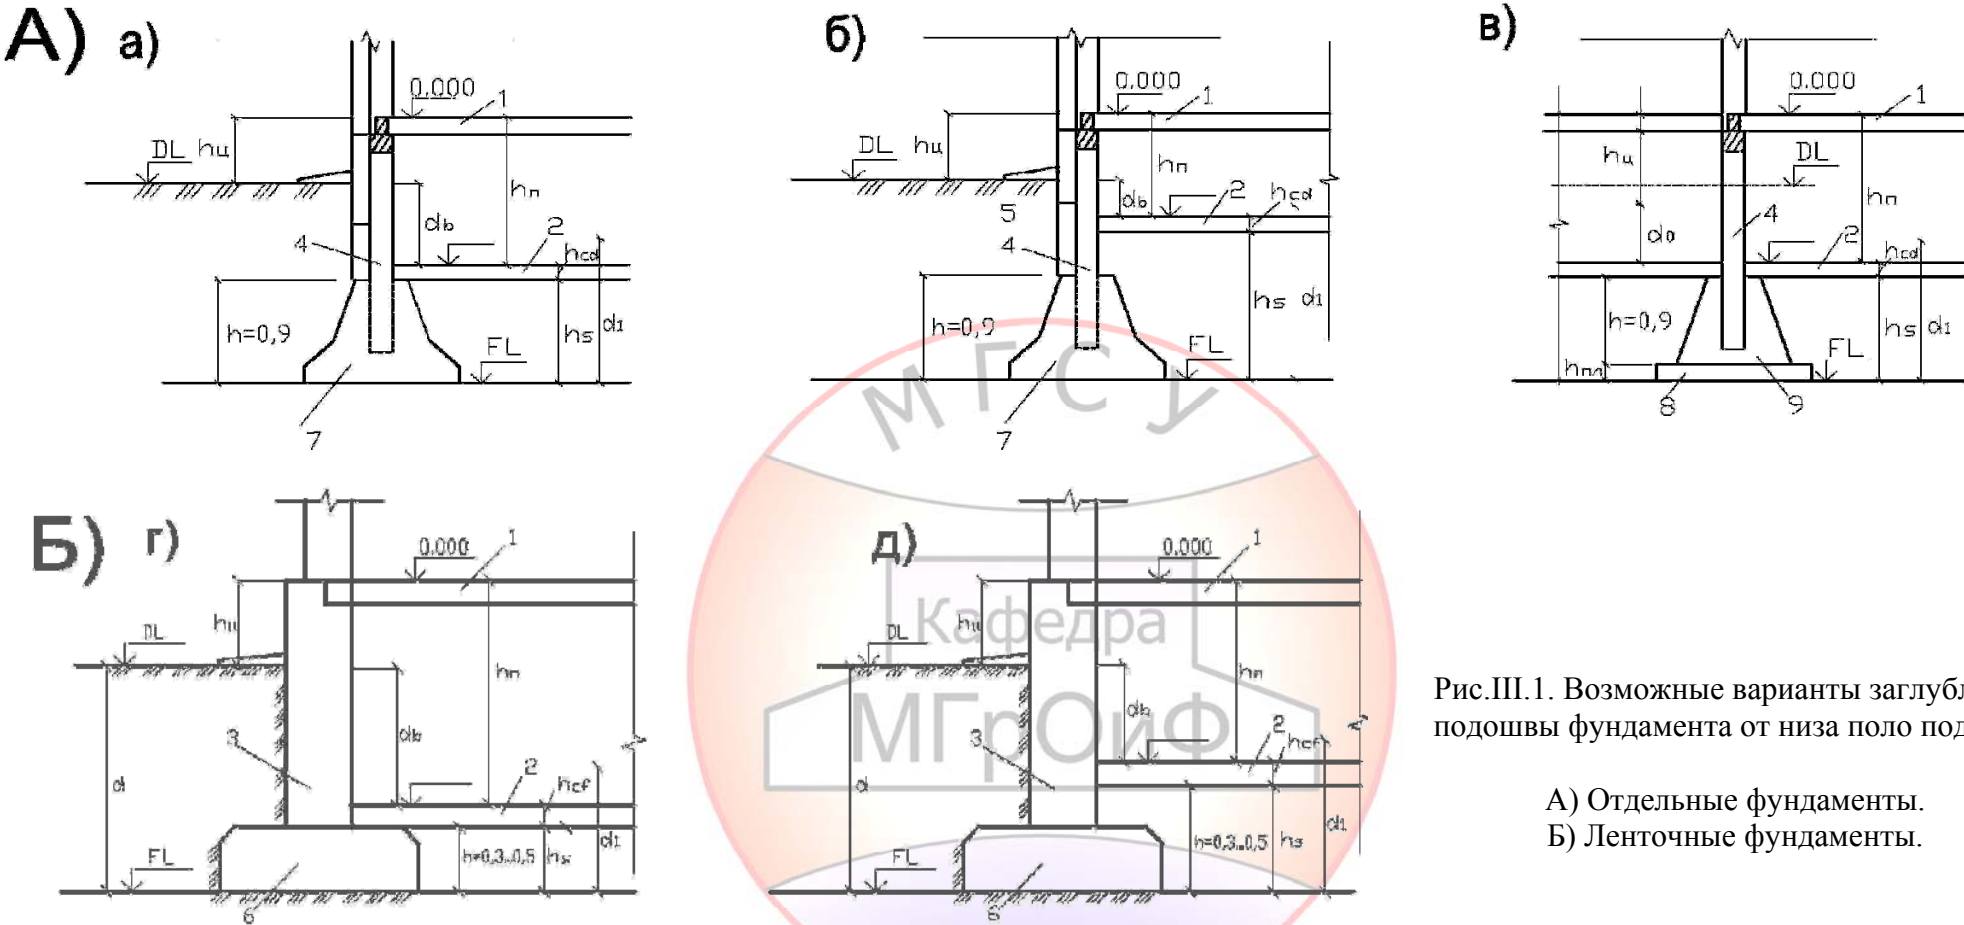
Возможные варианты заглубления подошвы фундамента от низа поло подвала.
